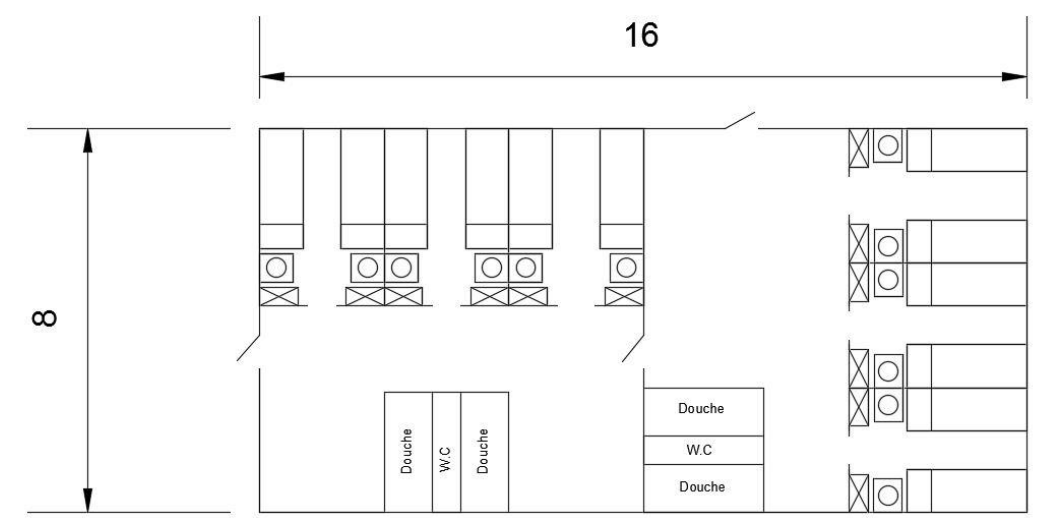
Plan Chalet (Autocad - Gwendal Le Pallec)
